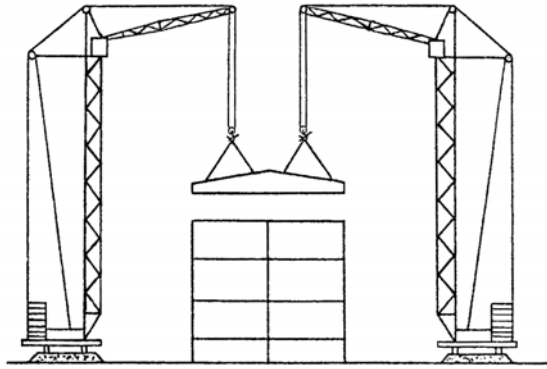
Схема спільного монтажу елемента покриття двома кранами (розріз 1-1 до рис. 4.16)
